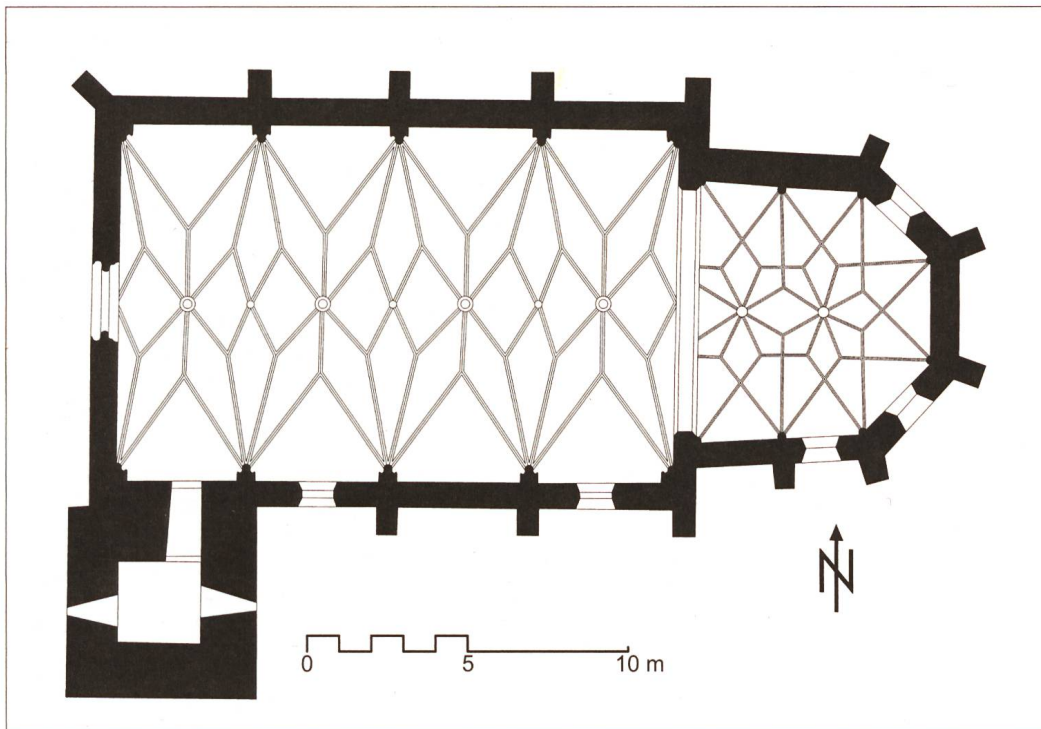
Grundriss der ref. Kirche St. Florinus in Ramosch aus Laserscans und tachymetrischen Messungen erstellt.
